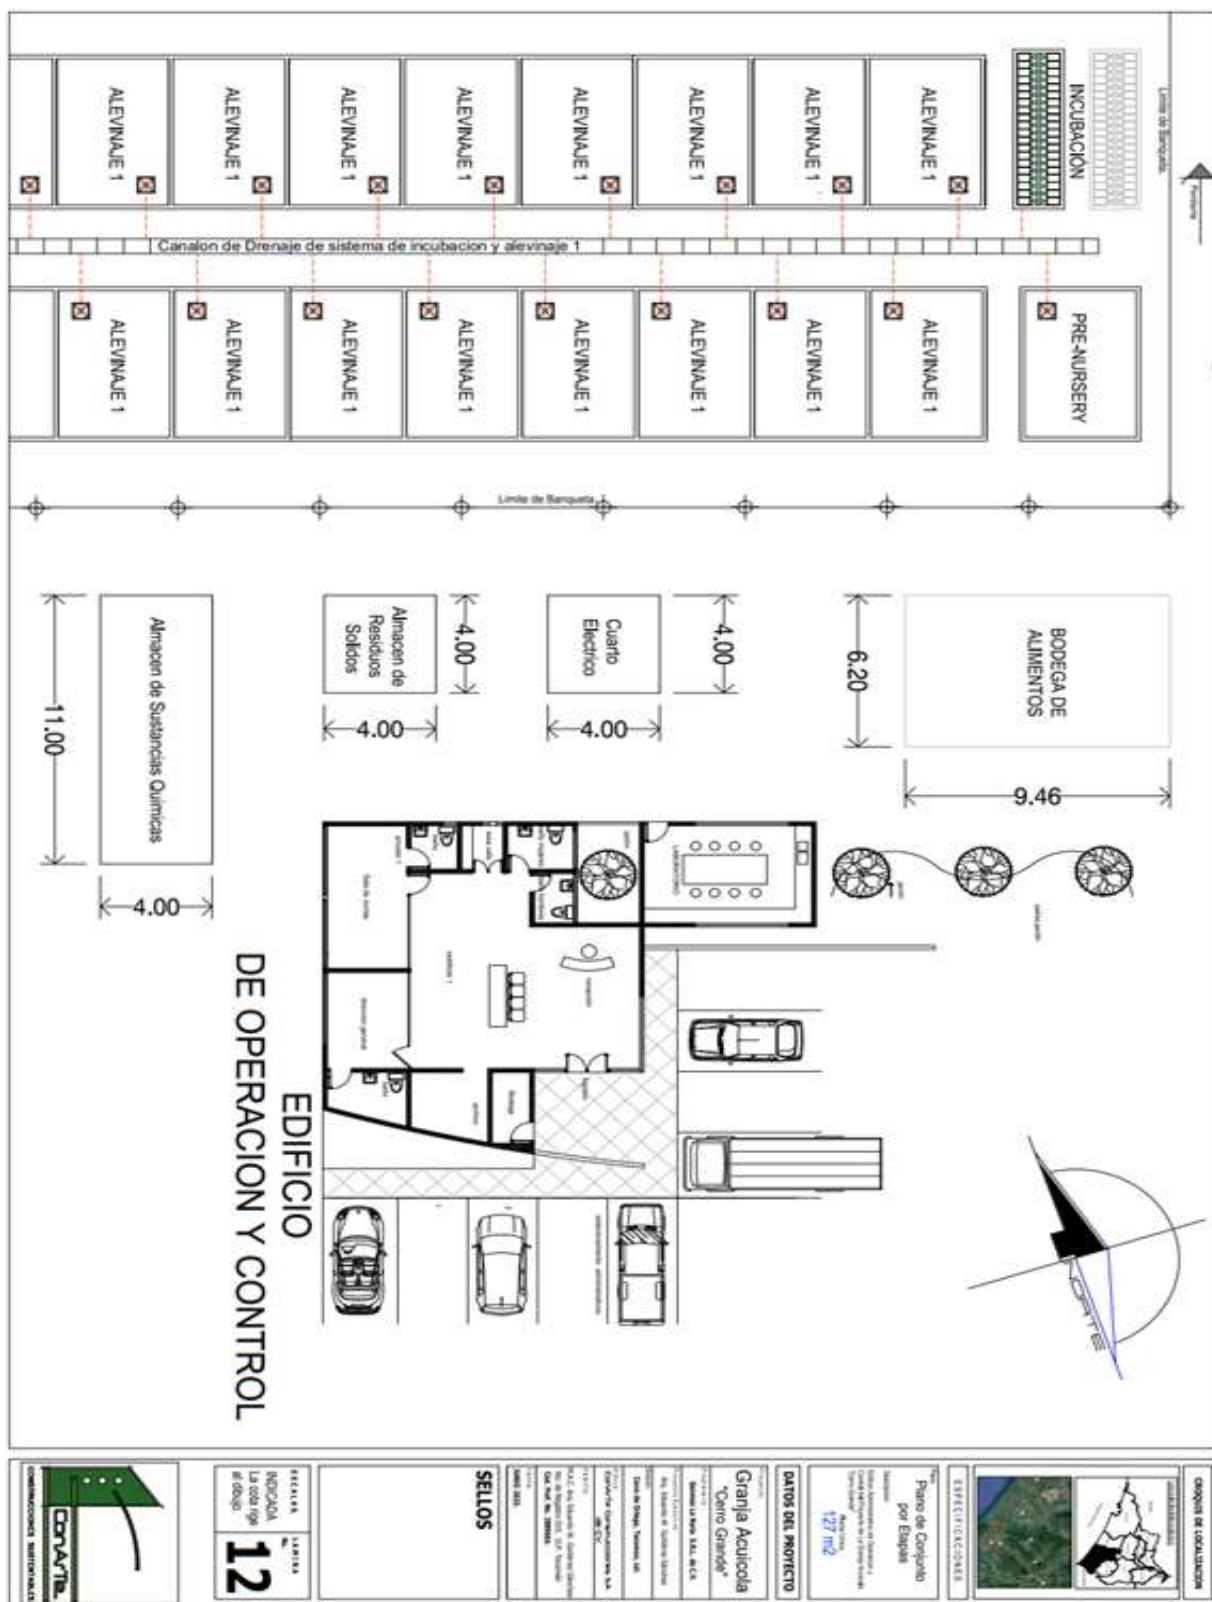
Anexo 3. Plano de las obras asociadas al proyecto, 2025.
